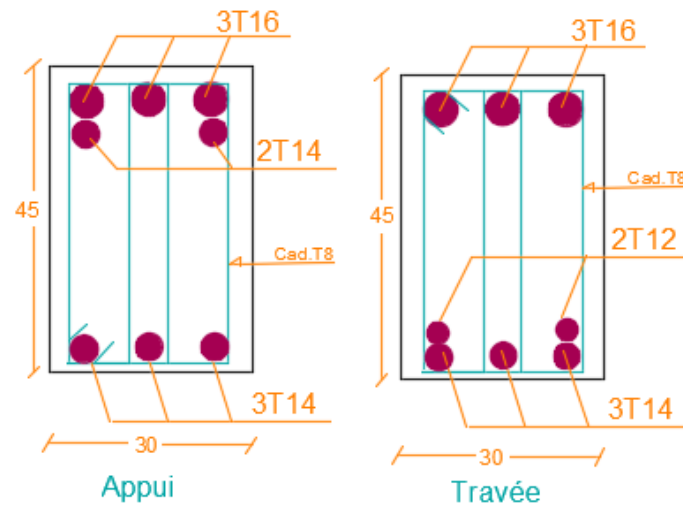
Ferrailage Des Poutres Non Porteuses Du Niveau Terrasse.
